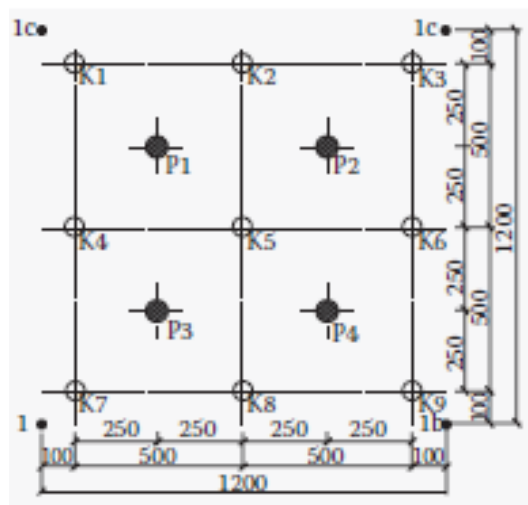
Localização das colunas *jet grouting* no local dos ensaios [41]
